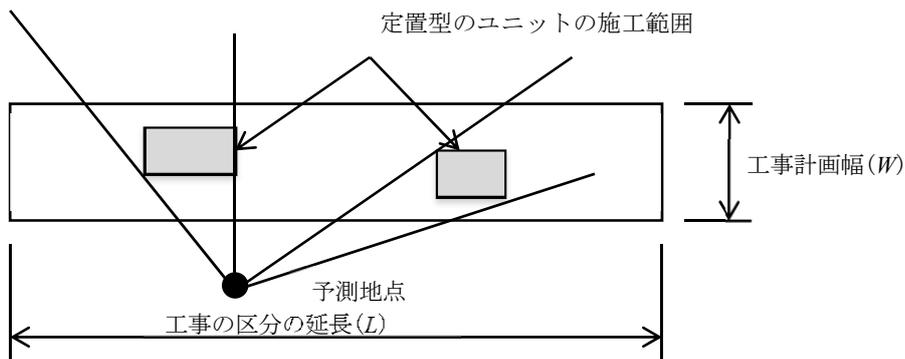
ユニットが定置機械作業の場合の施工範囲の設定例
